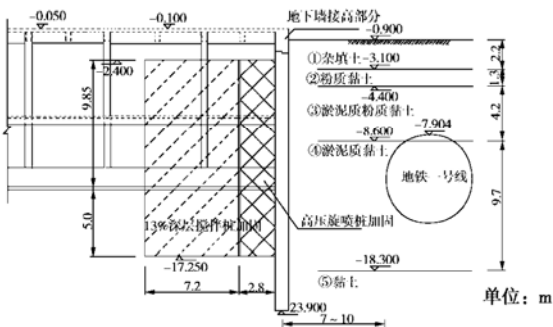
基坑及坑内加固与地铁运营隧道关系剖面图
